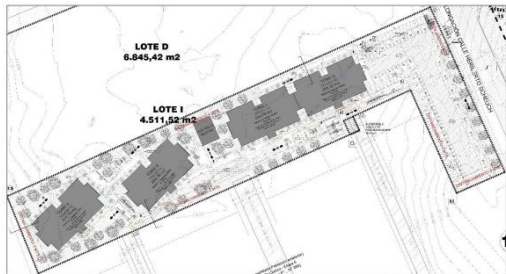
Plano planta – Lote I. Allegados Las Rosas
